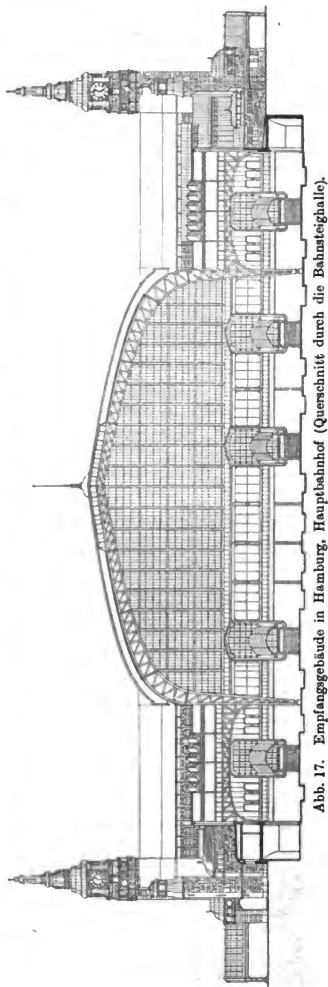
Empfangsgebäude in Hamburg, Hauptbahnhof (Querschnitt durch die Bahnsteighalle).
